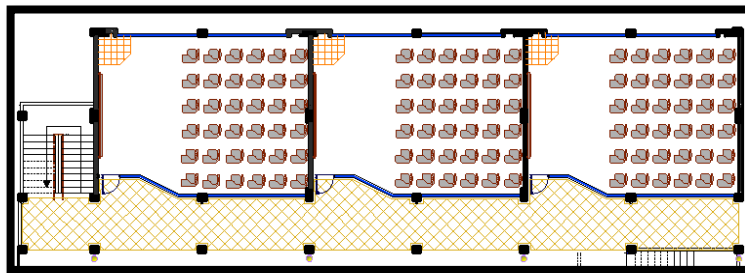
Planta segundo piso Bloque de aulas A y B.
